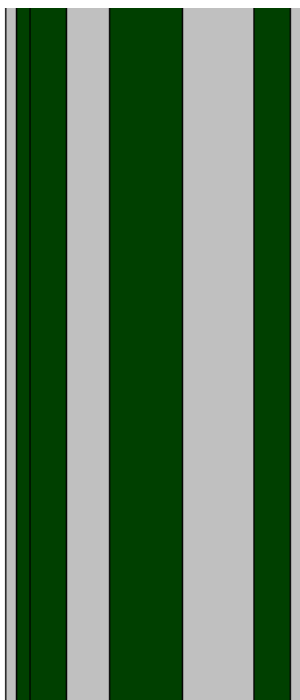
Elementvegg etterisolert med 70 mm EPS-isolasjon modellert i Therm 6
